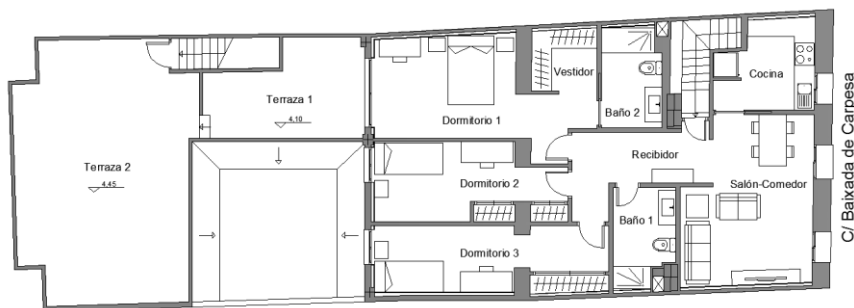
Distribución de la reforma de la vivienda de planta primera. 2014.
